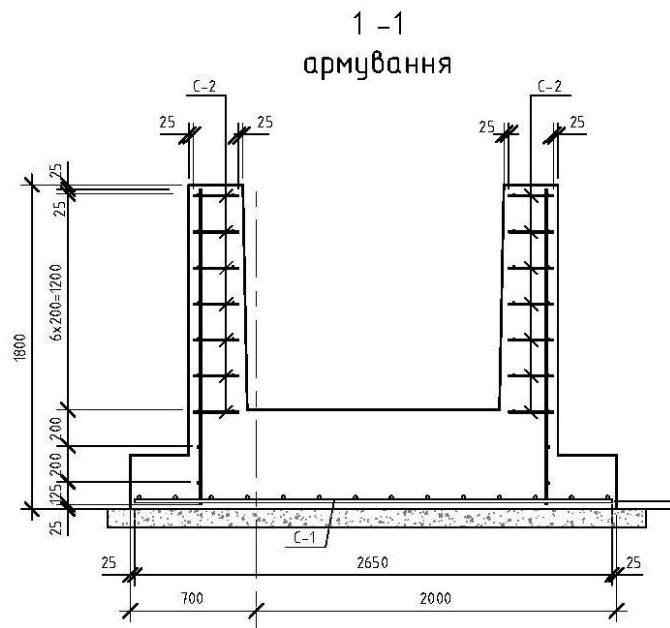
Схема армування фундаменту ФМ-1.
